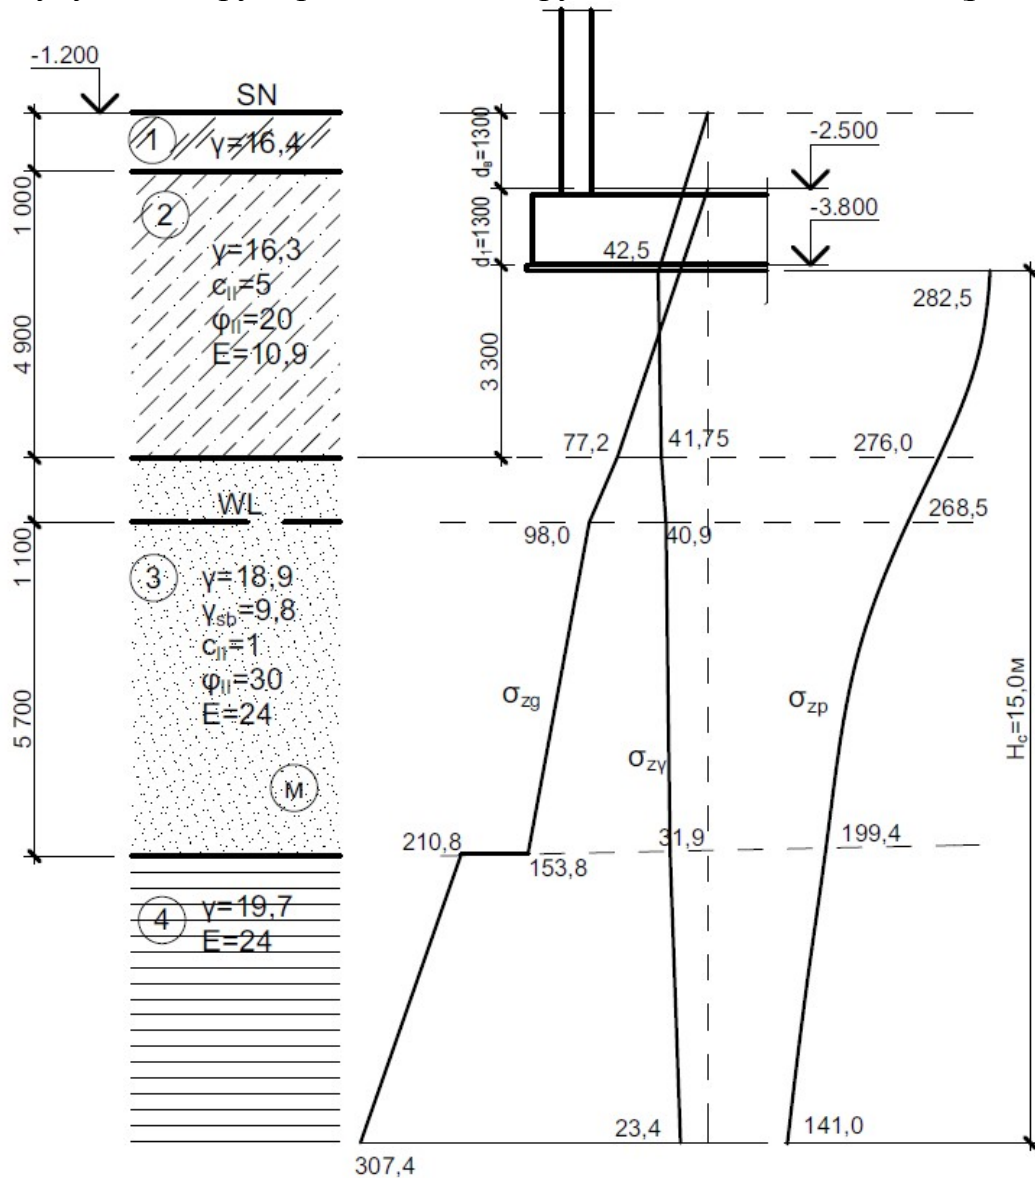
Розподіл напружень у ґрунті під плитним фундаментом
